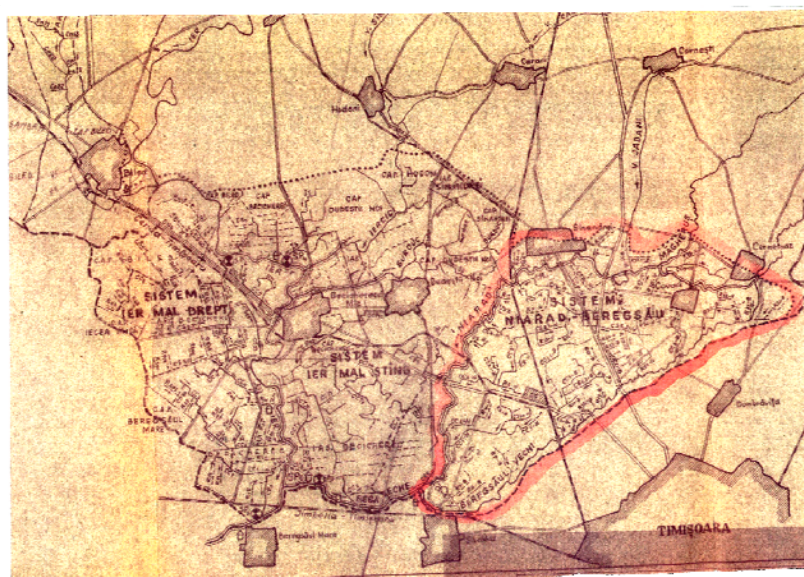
Plan încadrare și plan situație Amenajarea Vinga - Biled - Beregsău
